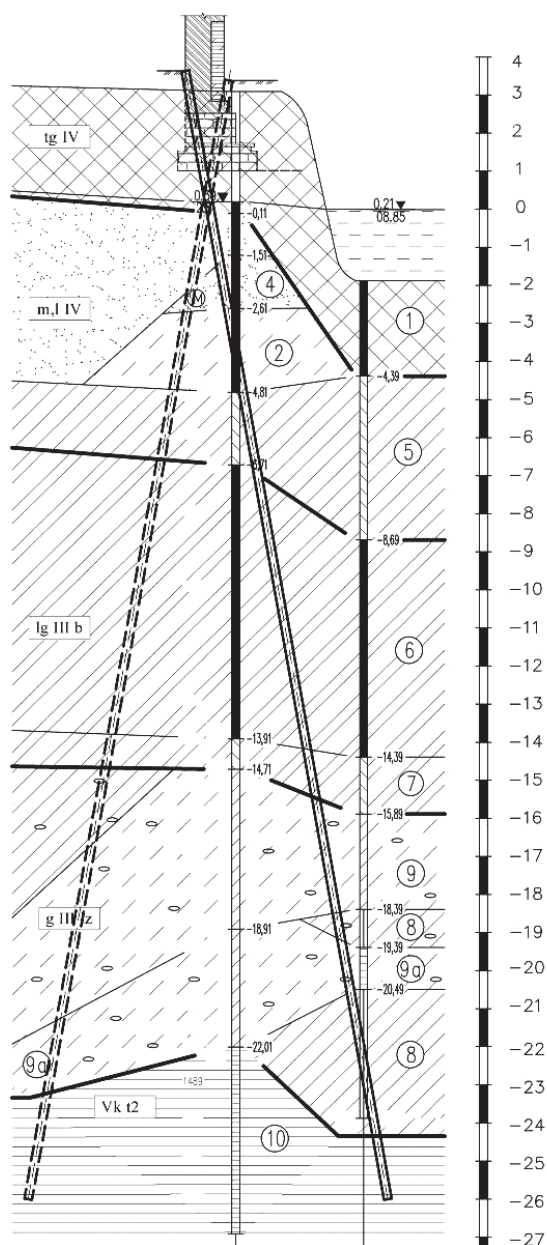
Общая схема решения усиления ленточного фундамента буроинъекционными наклонными сваями по козловой системе в инженерно-геологических условиях площадки
